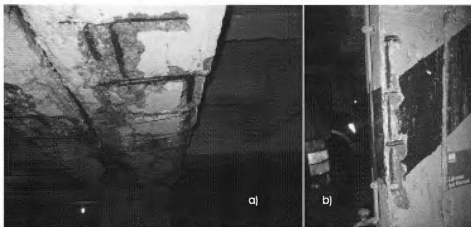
Daños principales observados en a) vigas y b) pilares ubicados en las juntas de dilatación
